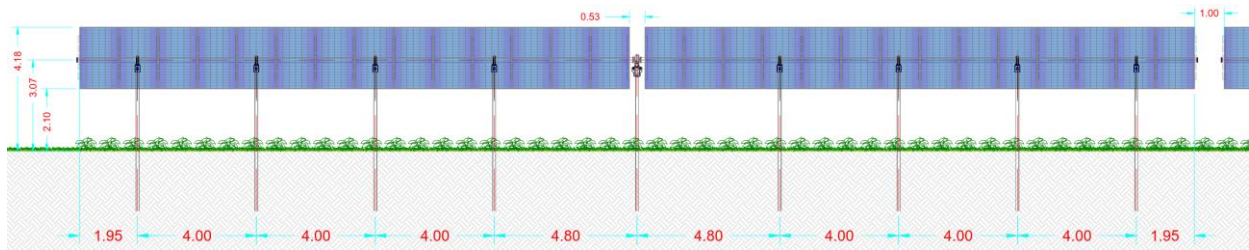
Sezione longitudinale tipologica struttura Tracker 28x1
